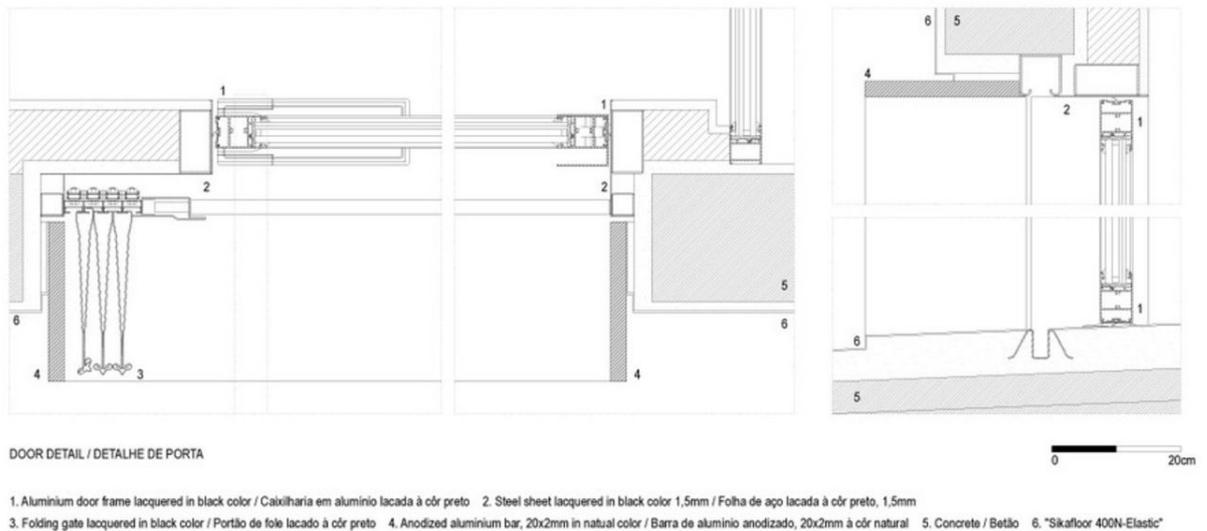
Detalhe aproximado porta de entrada, Gruta das Torres
